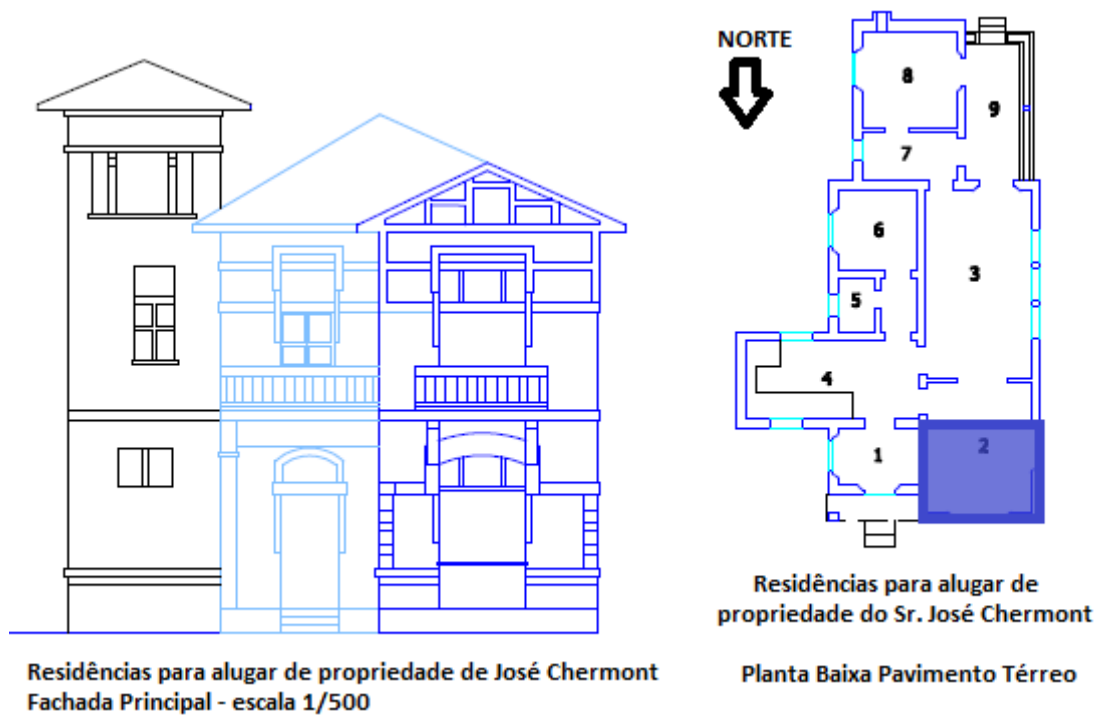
Esquema dos planos na fachada principal das residências para alugar de propriedade do Sr. José Chermont (07) na escala 1/500. O volume em azul escuro está em um primeiro plano, o volume em azul claro corresponde a um plano intermediário e o volume em preto está em um plano mais afastado, correspondente ao hall da escada na fachada lateral. Nenhum dos planos está no limite do lote. O volume destacado na fachada está marcado também na planta baixa ao lado.
